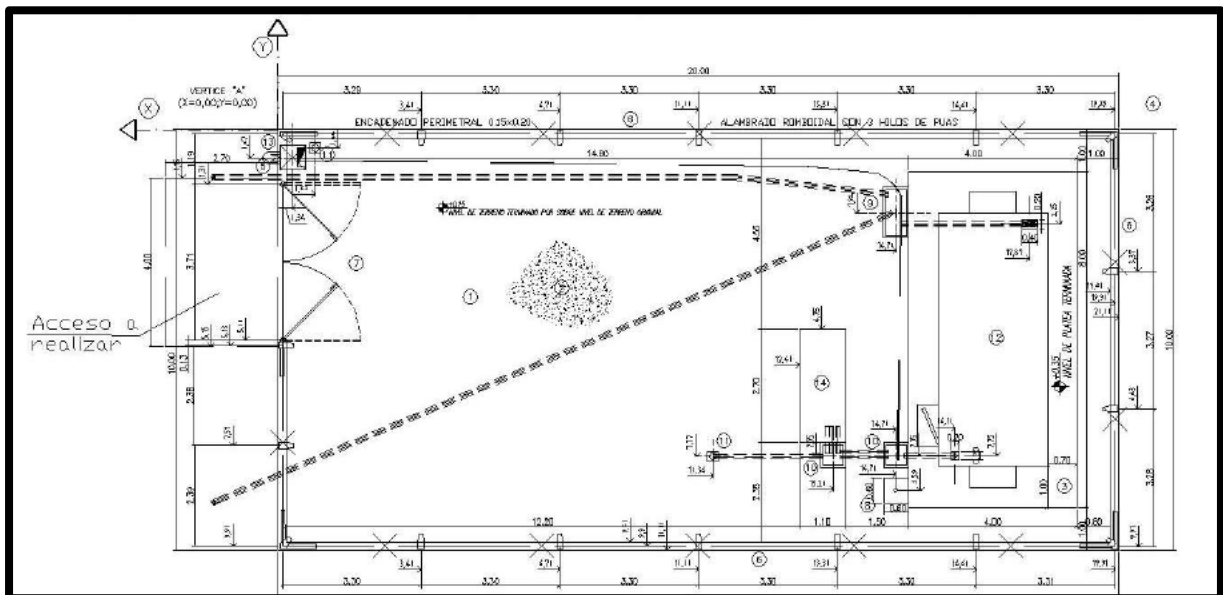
Esquema de Sitio para la construcción de un shelter. Fuente ARSAT (2021)
